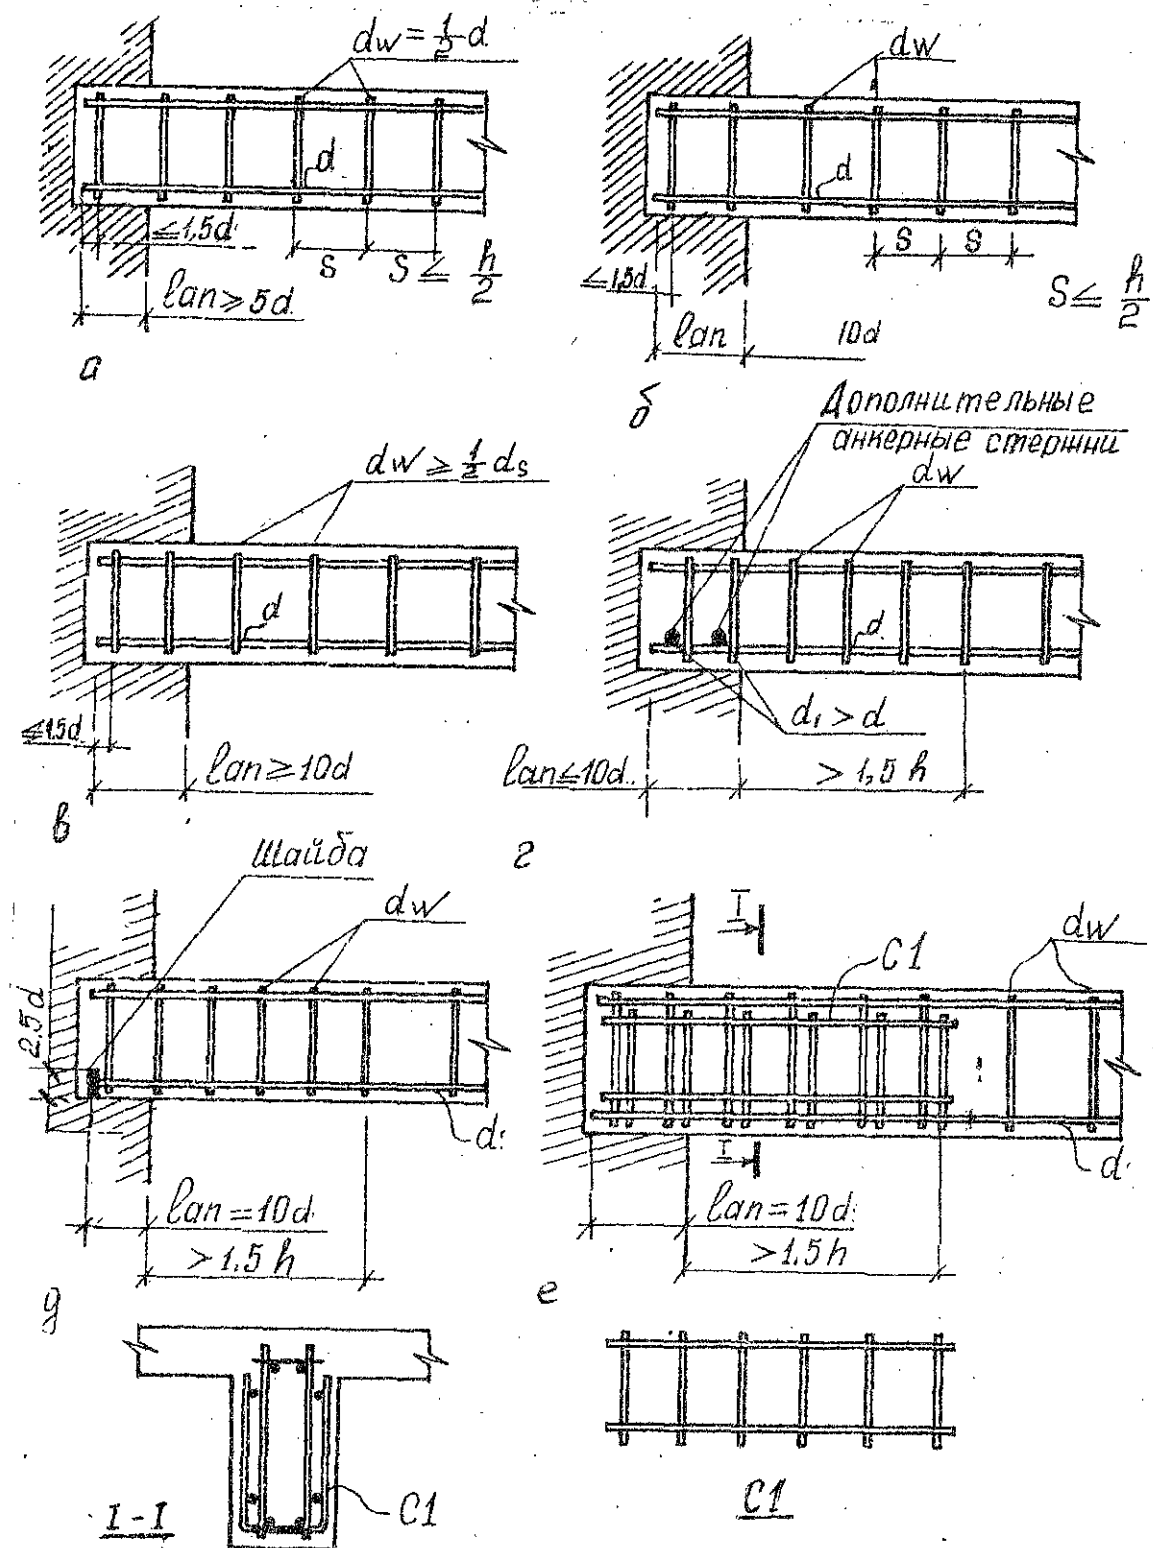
Анкеровка продольных стержней на свободной опоре балки: а — поперечная арматура по расчету не требуется; б — при размещении за гранью опоры двух поперечных стержней; в — при проектировании поперечных стержней по расчету; г — при уменьшении длины анкерования ℓ_{an} за счет дополнительных анкерных стержней; д — то же приварки шайб; е — при уменьшении длины анкерования ℓ_{an} за счет постановки дополнительной сетки С1
